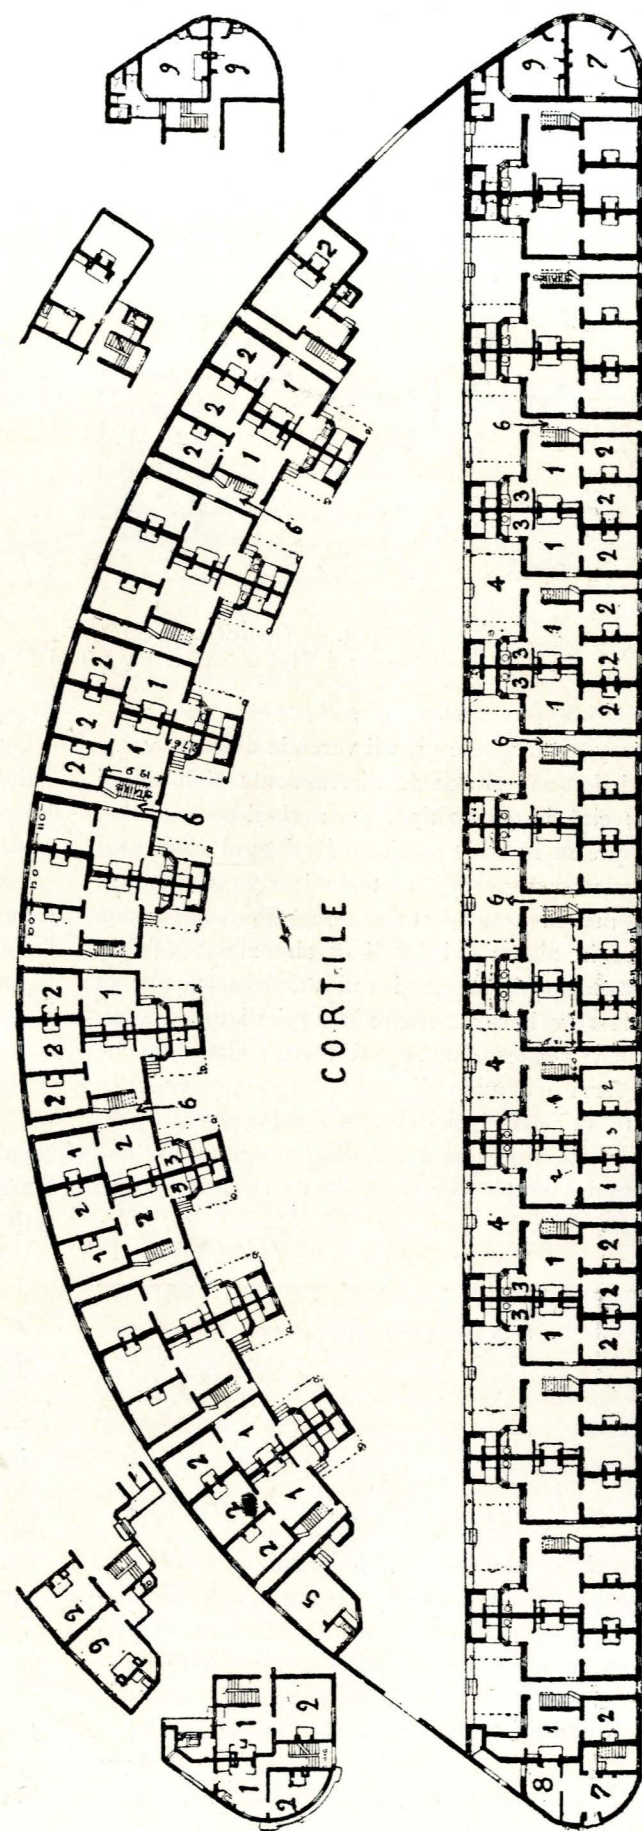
Pianta del piano terreno. — Quartiere completamente costruito dell'area N. 1.
